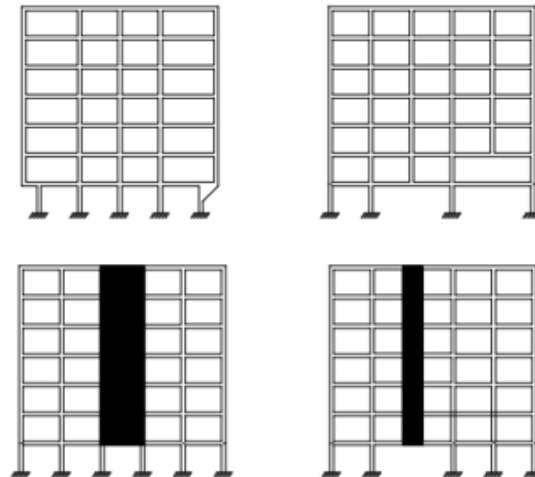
Exemplos de descontinuidade de elementos verticais (AFAD, 2018)
